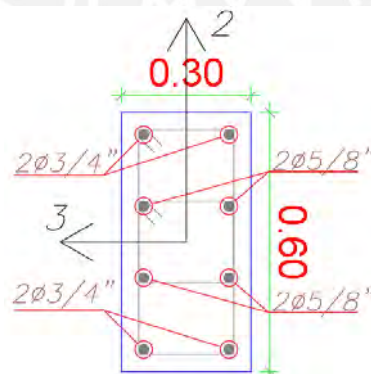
Disposición de armadura y ejes locales para la columna C4 (eje D-3)
